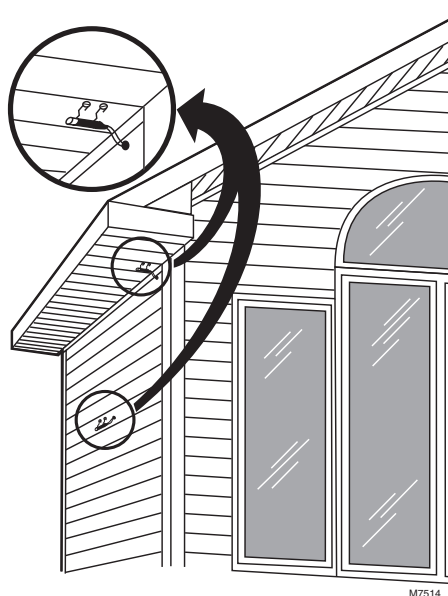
Endroits types pour installer le capteur de température extérieure C7089U1006.
